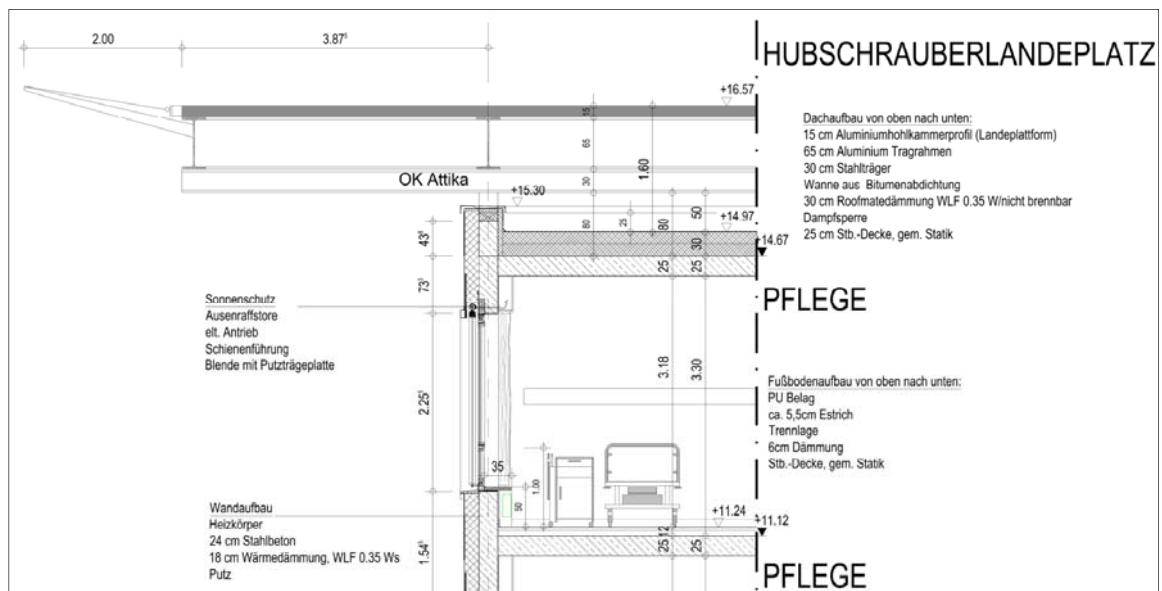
Fassadenschnitt des geplanten Bettenhauses mit Dachlandeplatz /15/
